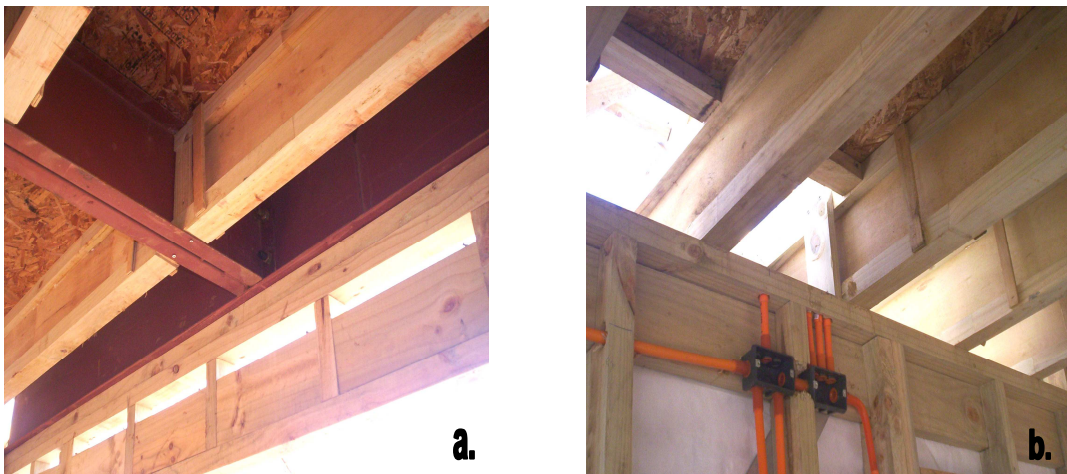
a. Vigas doble "T" con punto de apoyo en las correas metálicas b. Vigas doble "T" con punto de apoyo en el entramado vertical perimetral
